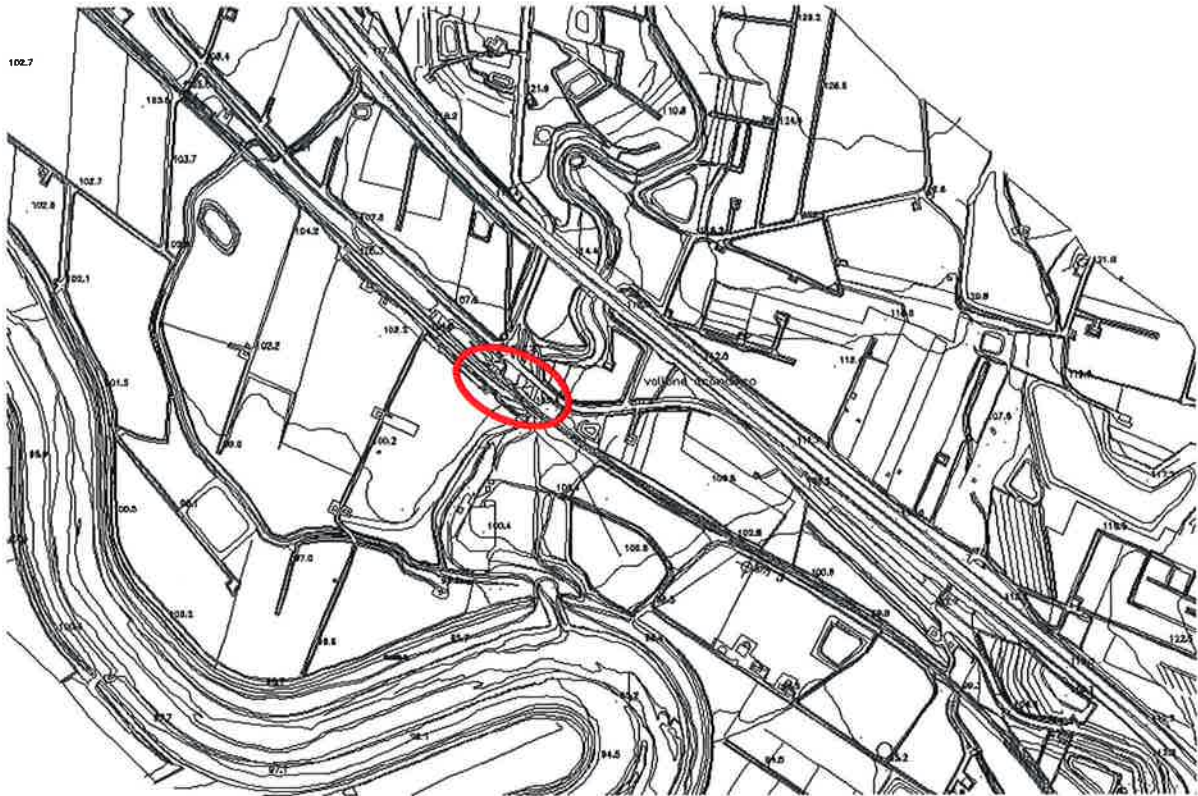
Individuazione planimetrica dei due attraversamenti stradali- Vallone Aranciaro
